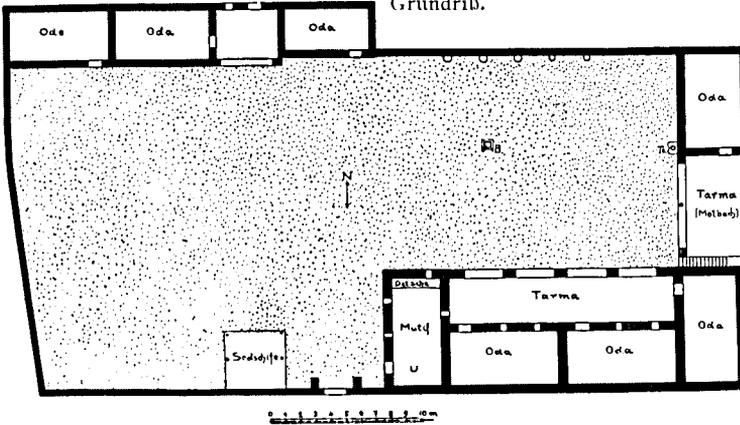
Haus des Habıb el Halawı, Koweiresch. Grundriß.
